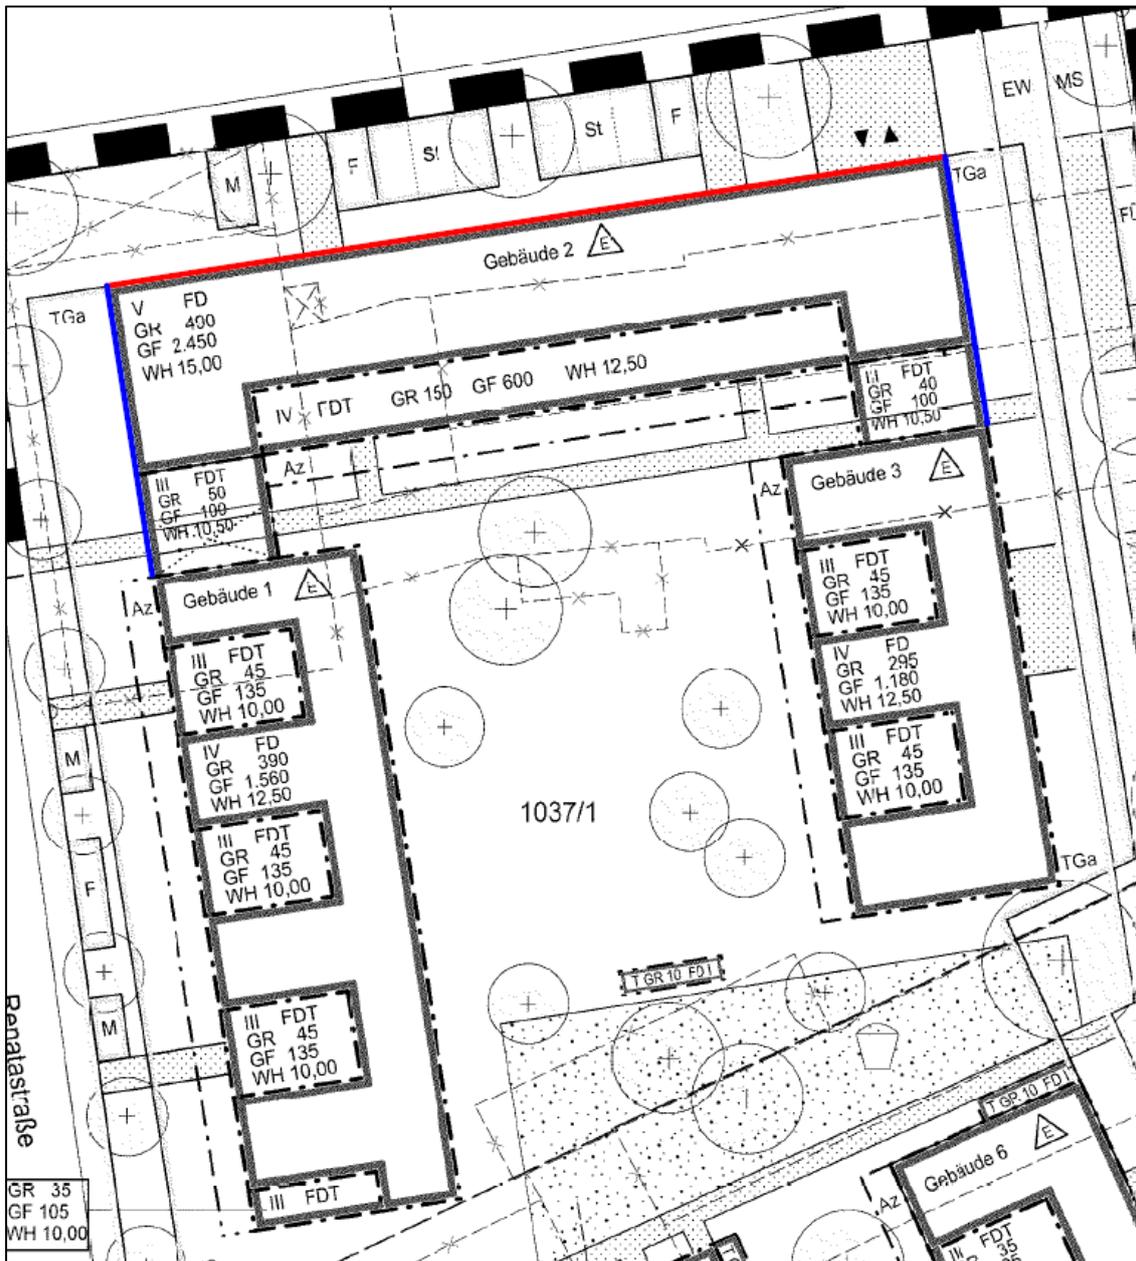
Lageplan mit Kennzeichnung der Fassaden mit Festsetzungen zum Schallschutz
